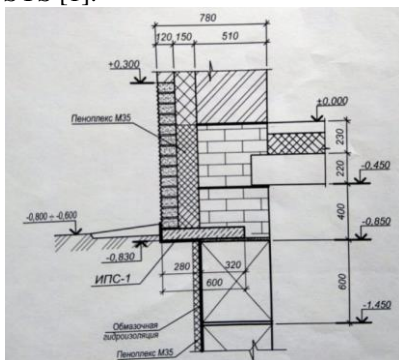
Опиране наружной кирпичной стены на плиту ИПС
